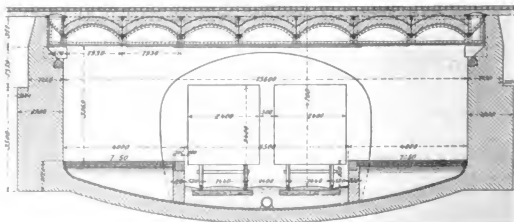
Querschnitt einer Station mit gerader Decke, 1:150.
